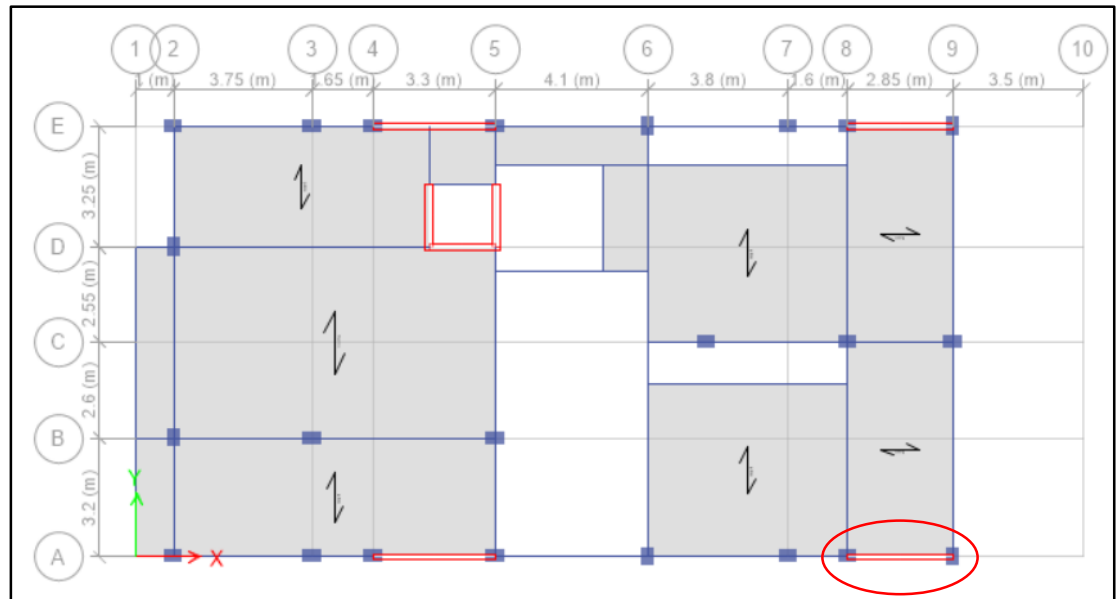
Modelamiento en planta y ubicación del muro de corte a diseñar.
